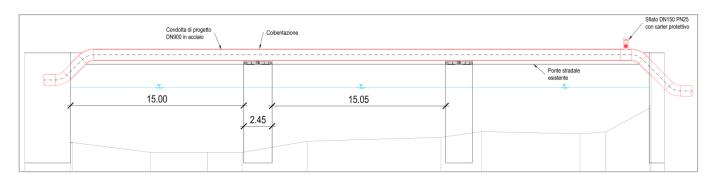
Sezione longitudinale attraversamento aereo di progetto sul fiume Aventino.
